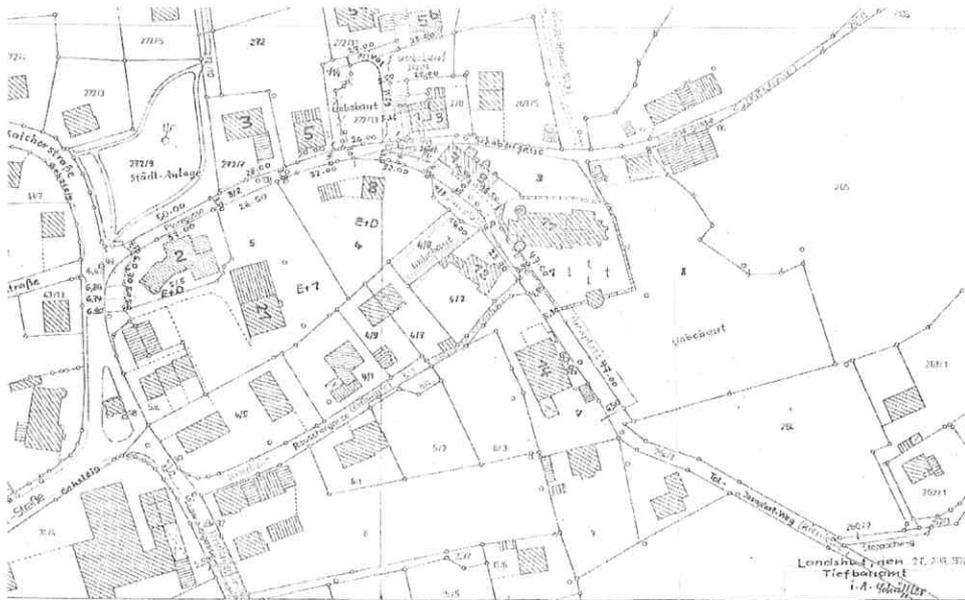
(Plan Staubfreimachung vom 28.08.1978)
